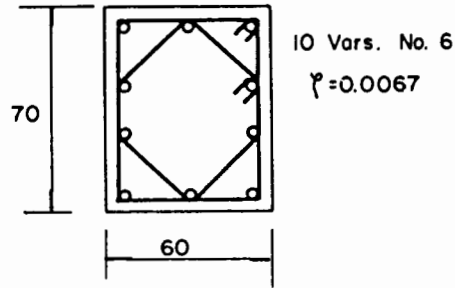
Armado de columnas usando RCDF-87 y Q=2
